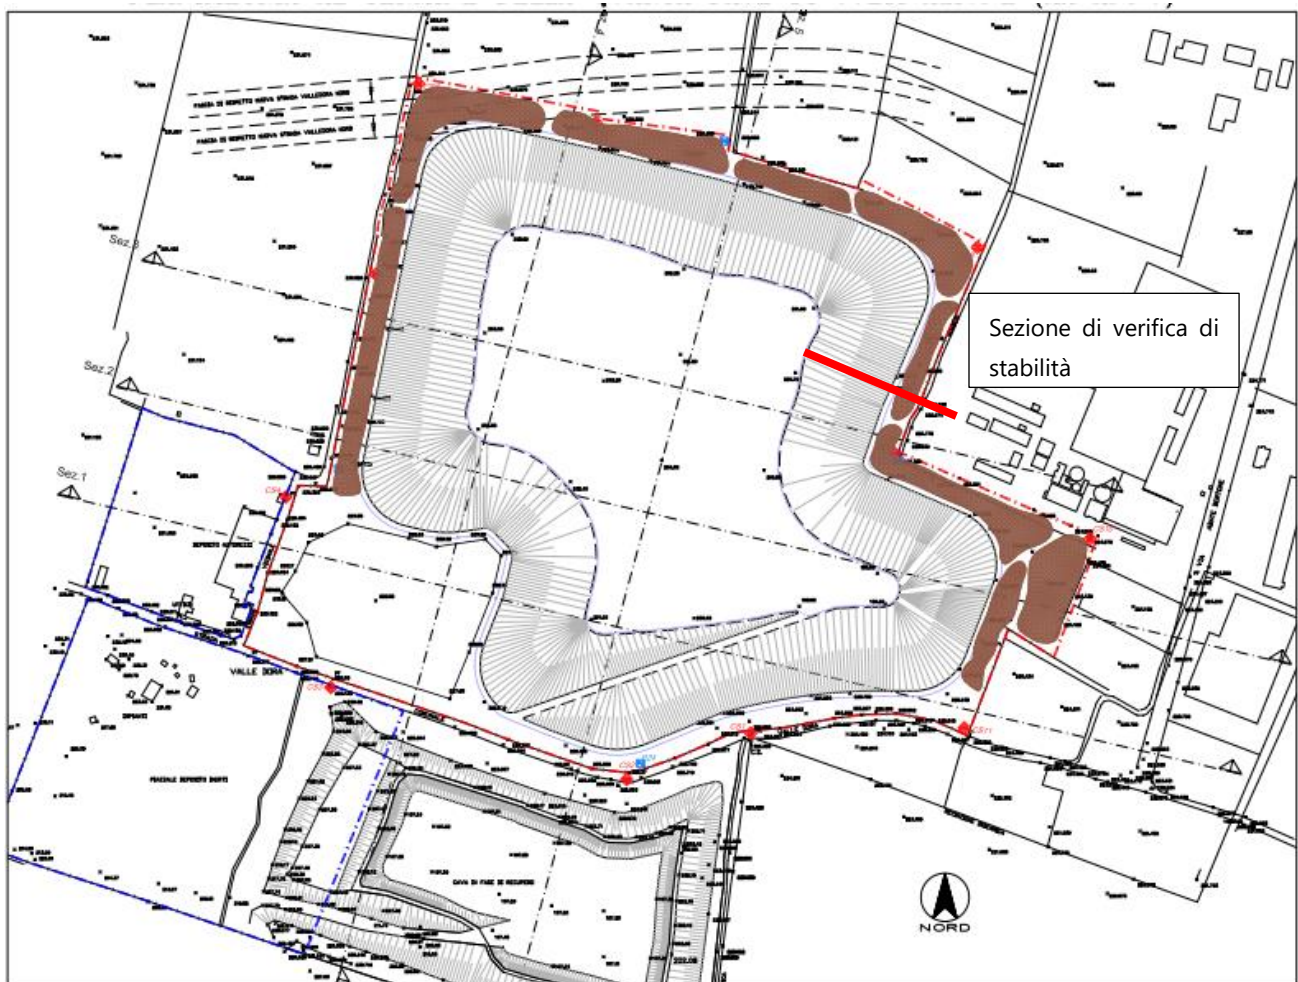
Planimetria indicativa della cava Bettoni con la sezione di verifica di stabilità
